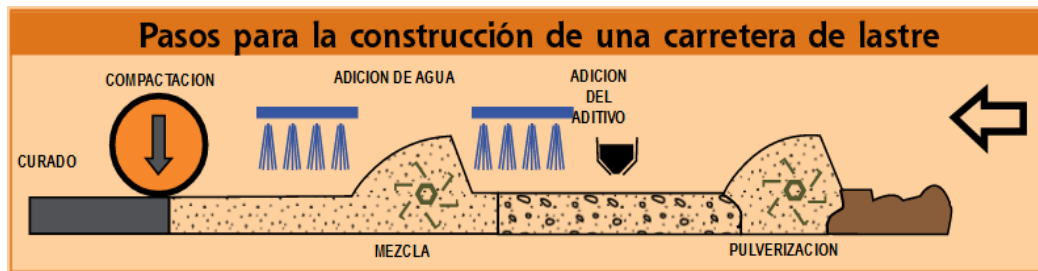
Pasos para la construcción de una carretera de lastre.
